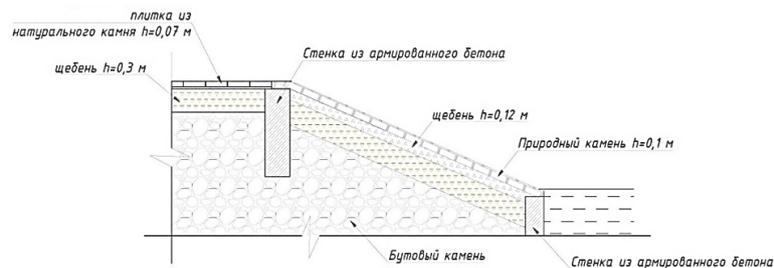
Схема конструкции набережной с покрытием из природного камня
